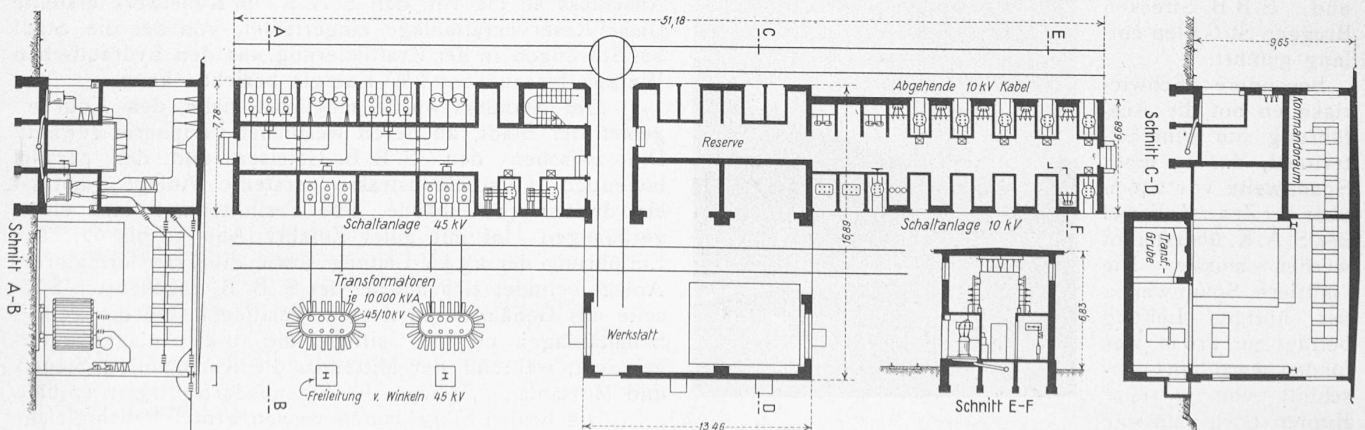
Grundriss und Schnitte 1 : 400 des Unterwerks Walenbüchel bei St. Gallen der Sernf-Niedererbach-Kraftwerke.
